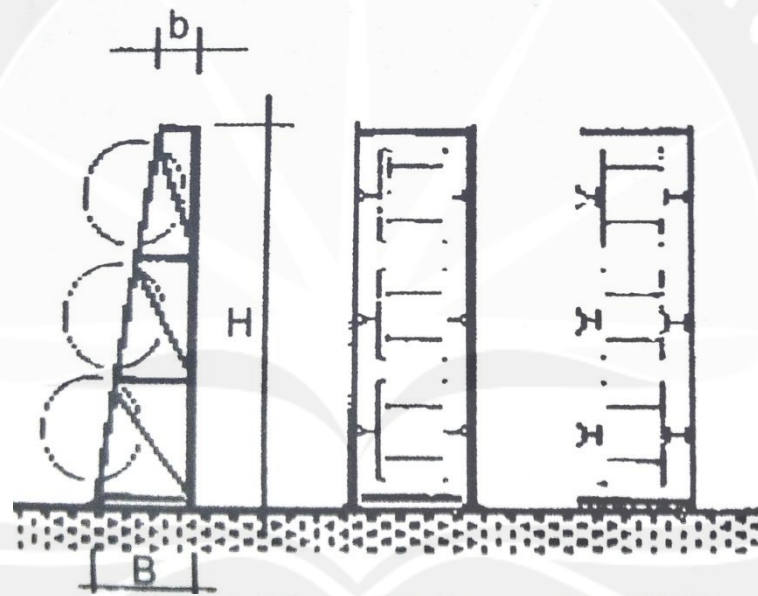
Rak Panjang dengan ukuran 600-1000mm
